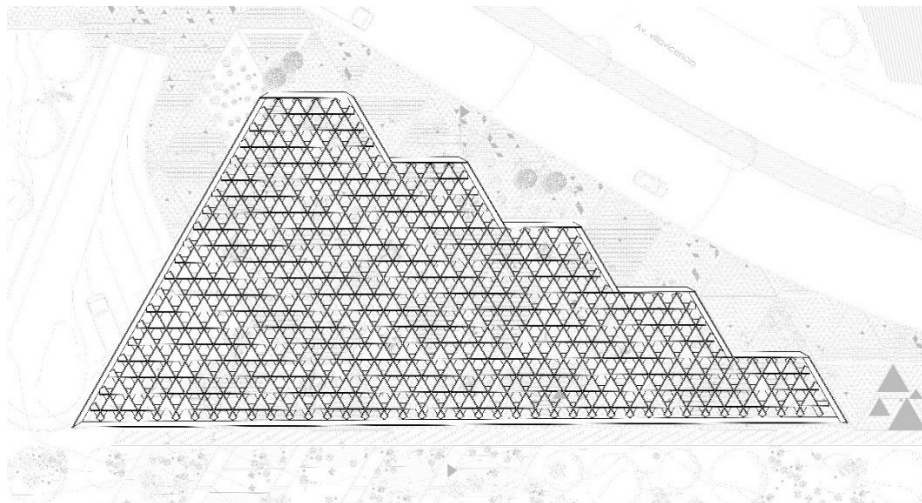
Planta de cubierta. Fuente: elaboración propia. 2017. CC BY-NC-ND
